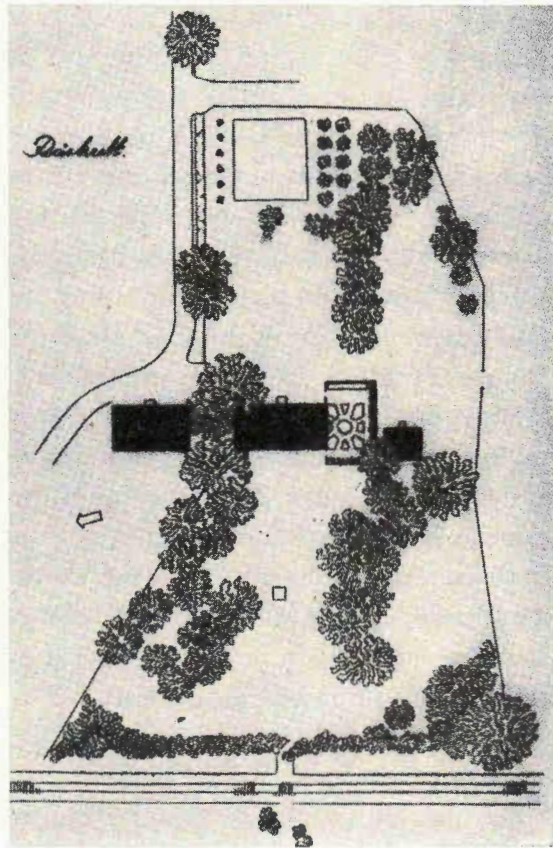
Plan över Råshult enligt rekonstruktionsförsöket.
